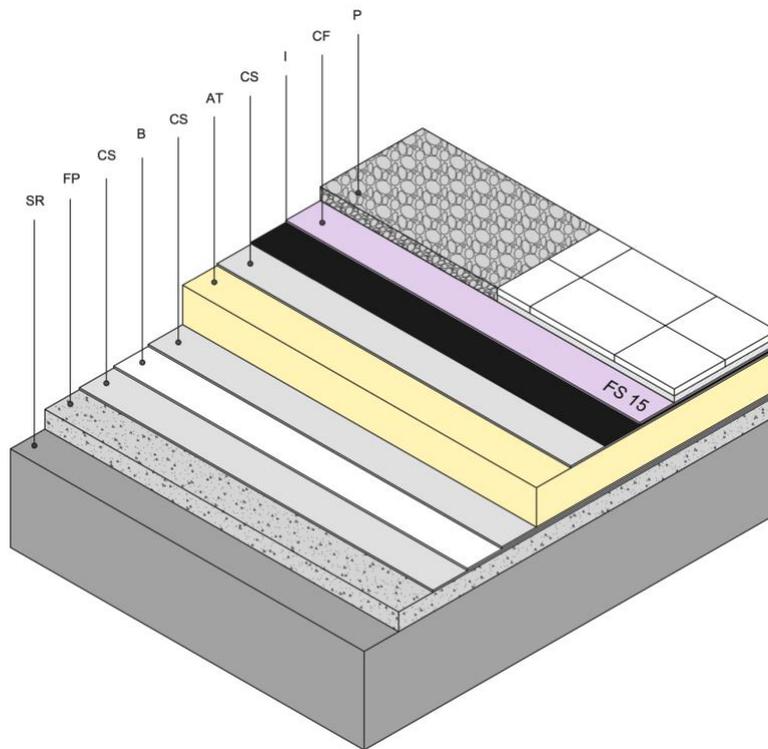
Posición capa filtrante en cubierta convencional. Leyenda: SR Soporte resistente. FP Formación de pendiente. CS Capa separadora. B Barrera corta vapor. AT Aislante térmico. I Impermeabilización. CF Capa filtrante. P Protección (grava o pavimento cerámico).
